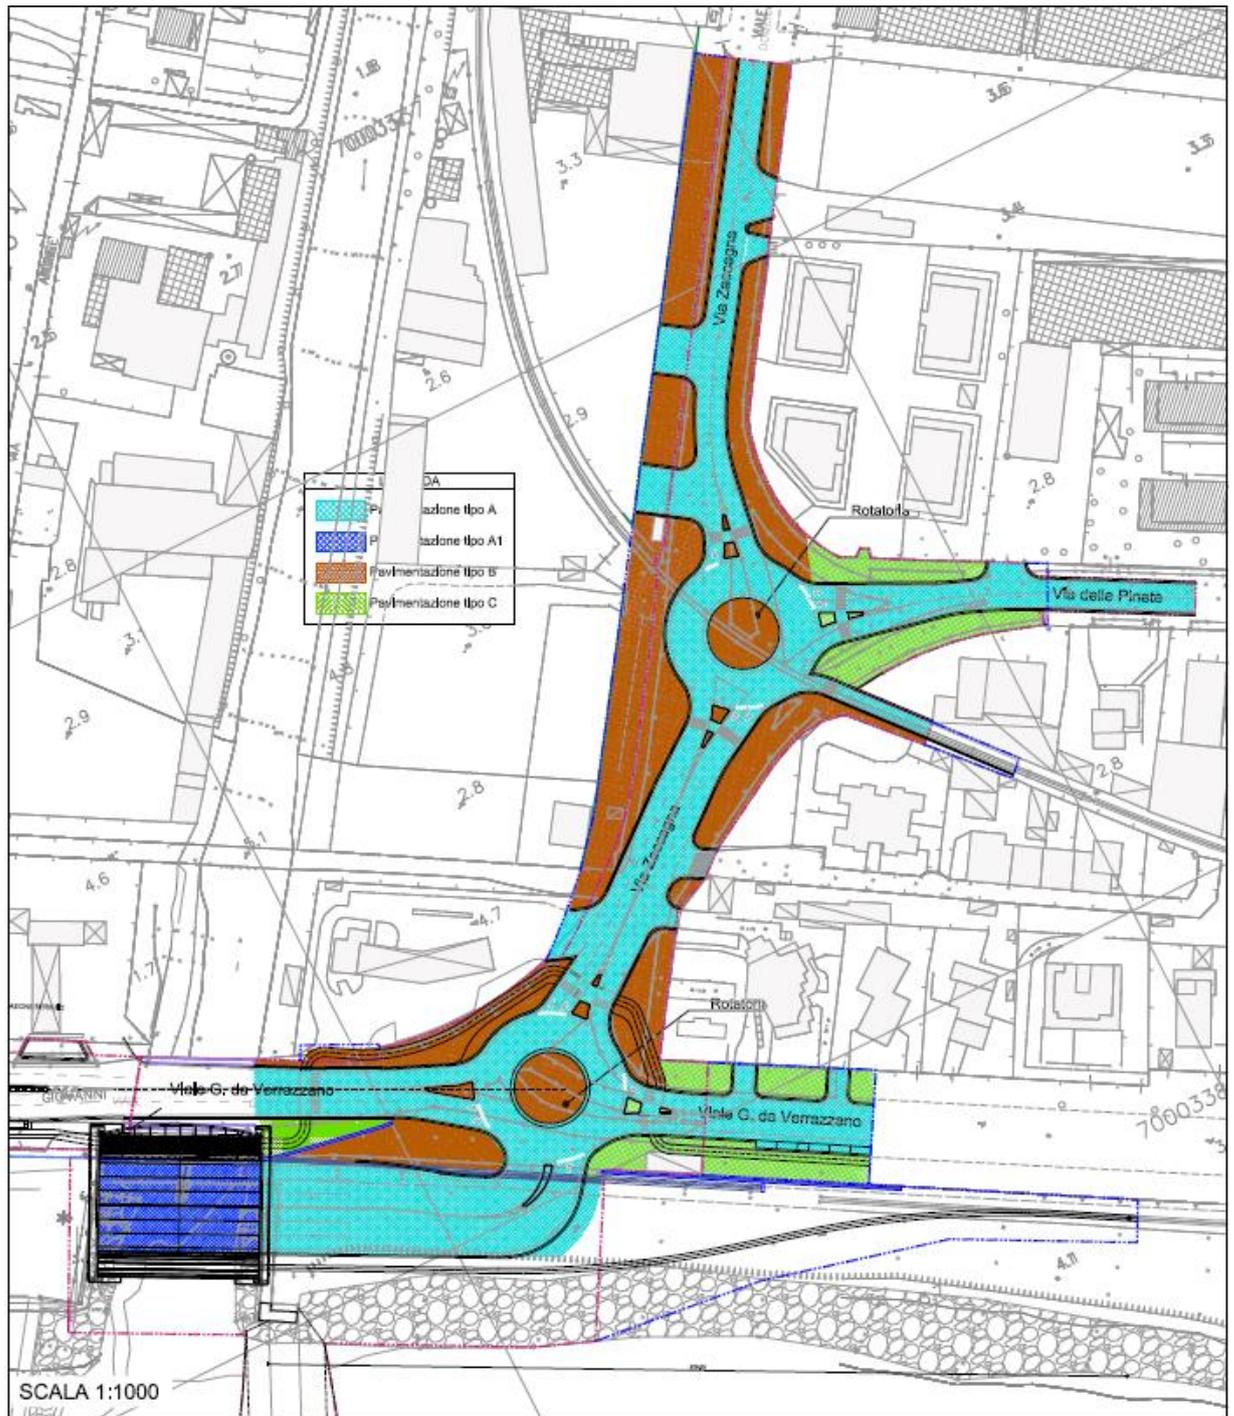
Planimetria delle opere previste nell’Ambito 1 (fonte: Elaborato OV.05.01 - AMBITO 1: “Opere di Viabilità – Stato di progetto”)
